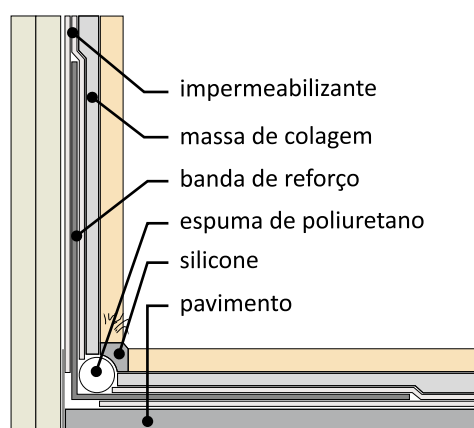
Reforço do sistema de impermeabilização no perímetro inferior do compartimento e cantos ou encontros verticais.
